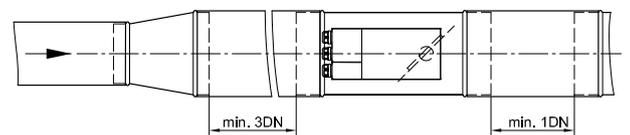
Einbau nach Störstelle, z.B. Aufweitemen
